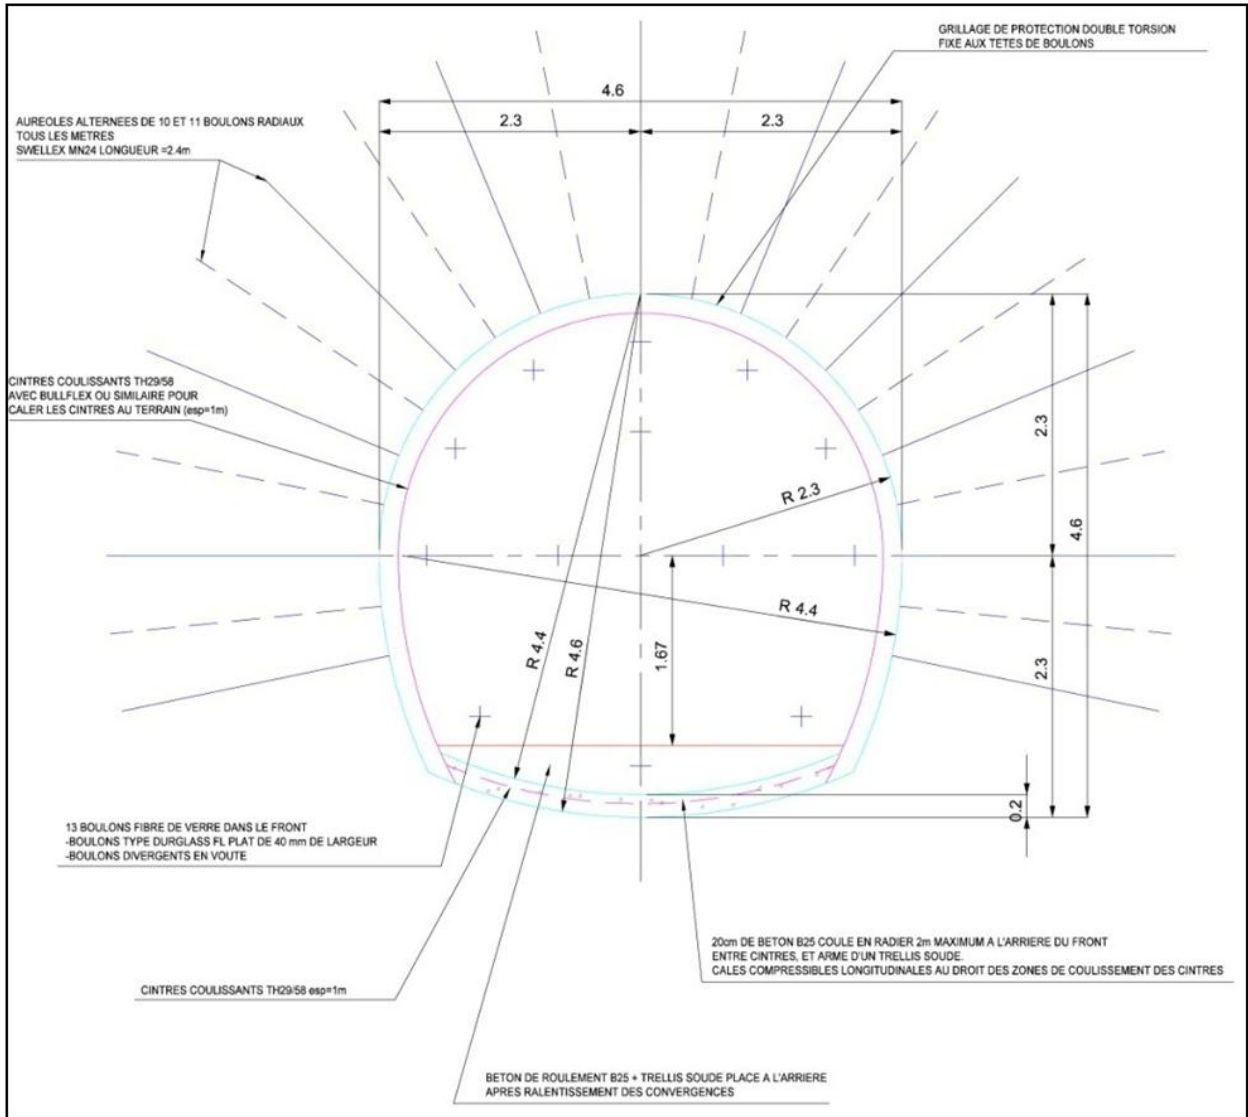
Section type de la zone SDZ et de la galerie GED.
